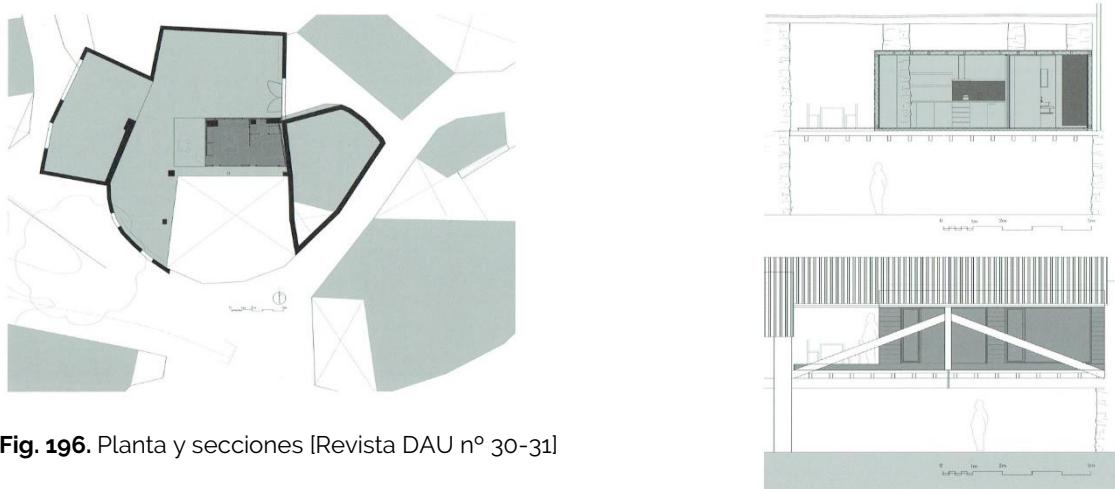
Planta y secciones [Revista DAU nº 30-31]
